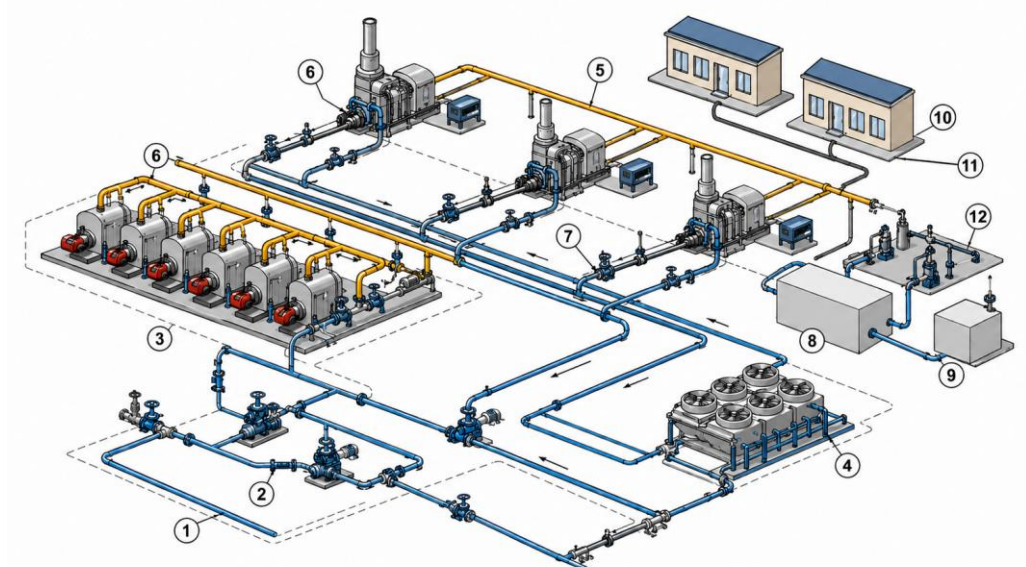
Схема розташування обладнання компресорної станції
